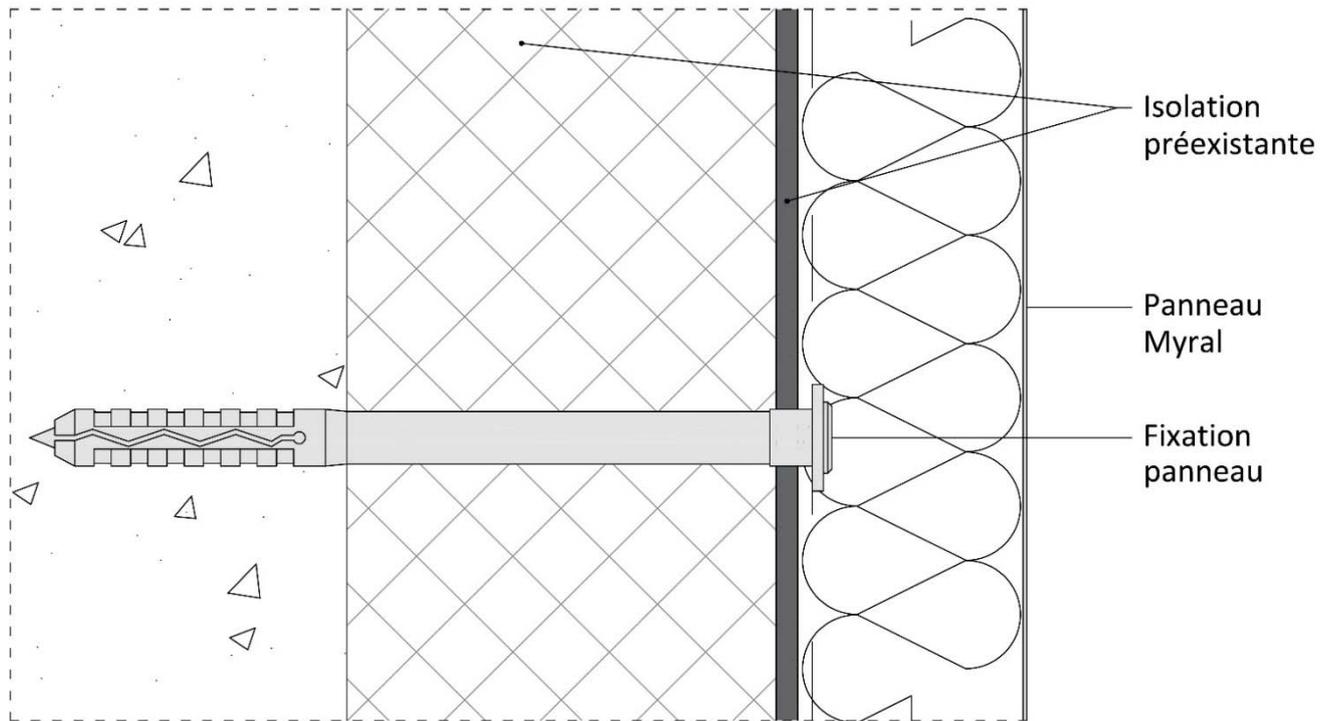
Pose des panneaux MYRAL sur paroi inclinée à fruit négatif (coupe verticale)
